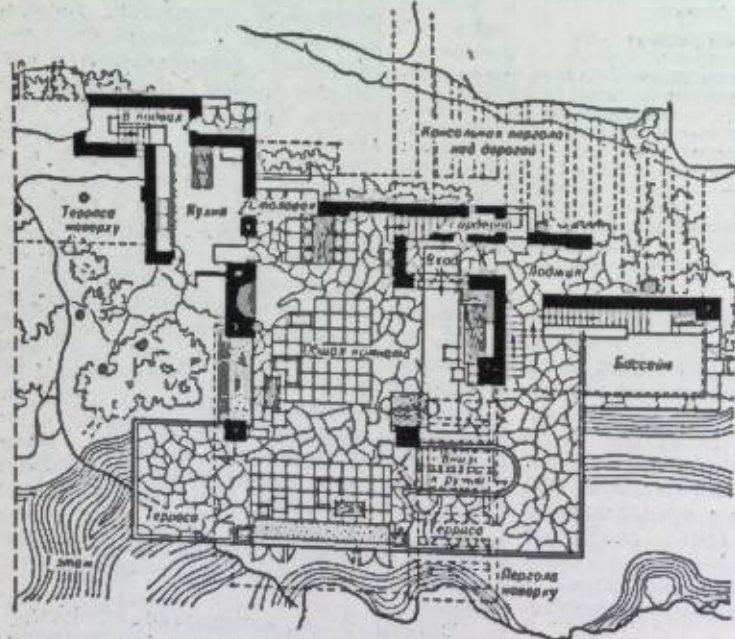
Жилой дом «Водопад». План 1-го этажа.
